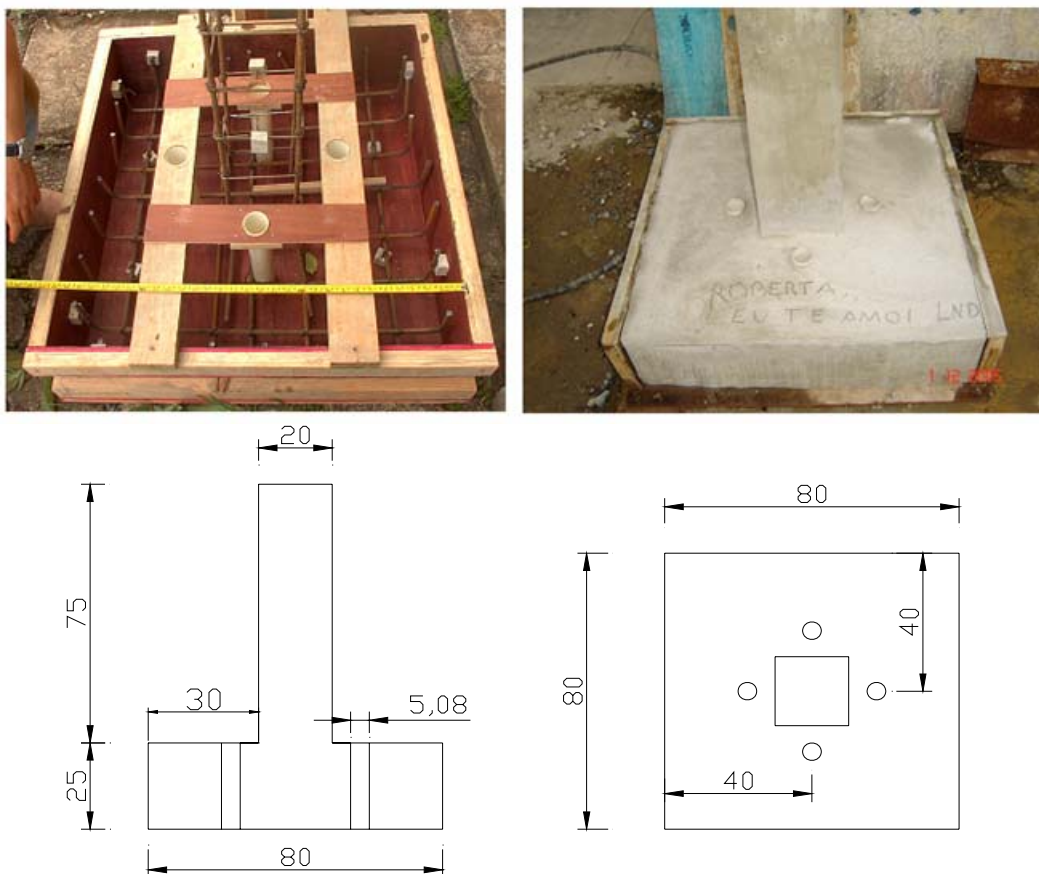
Aspecto geral da sapata pré-fabricada de concreto armado (dimensões em centímetros)
